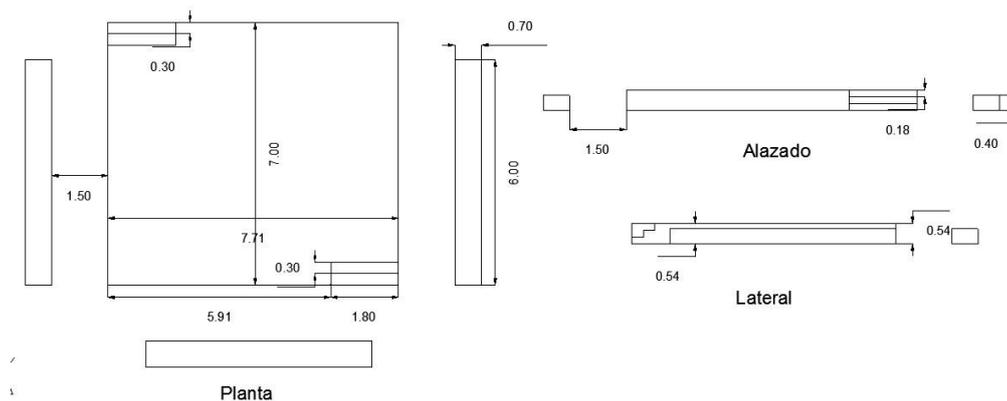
Detalle técnico de Escenario Monolítico de Hormigón
